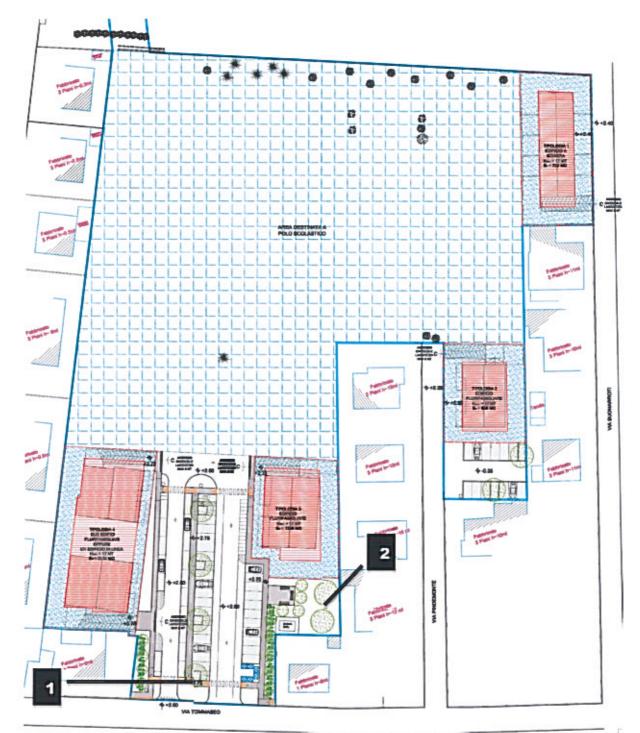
c – Planimetria di progetto del P.P. della Scheda 13.19. Sono numerate le modifiche del PP rispetto alla scheda di Variante presentata nel 2009
